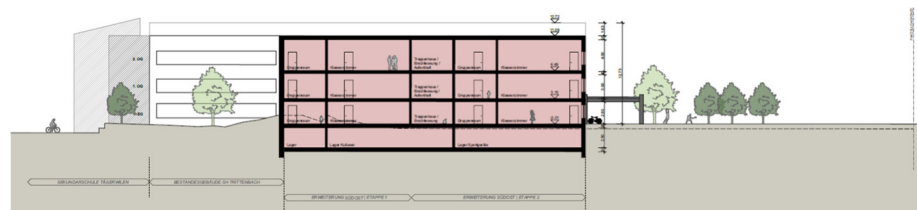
Disposition 1.2 | Gebäudeschnitt A-A
